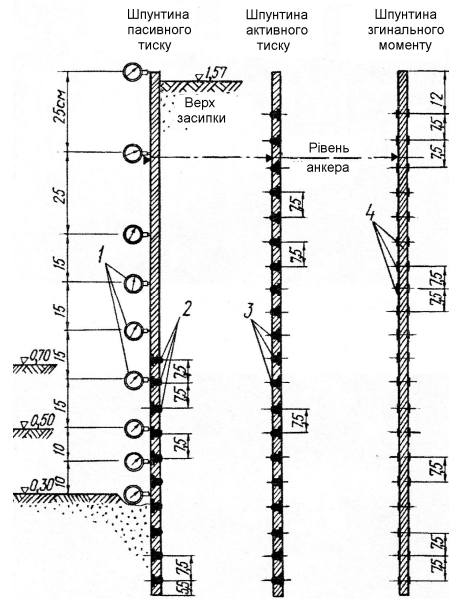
Схематичні поздовжні розрізи моделей шпунтових паль із встановленими вимірювальними приладами
